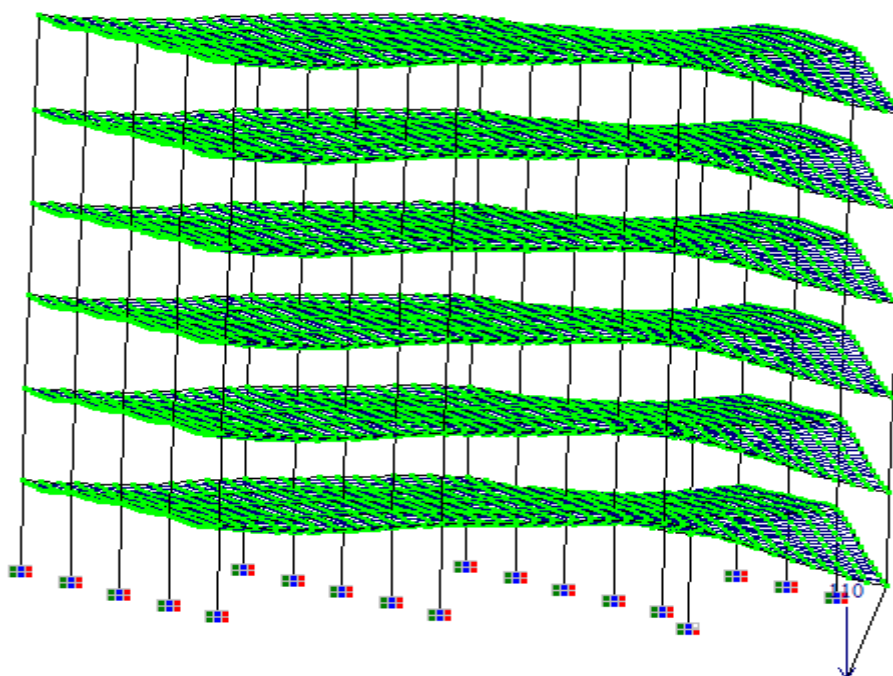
Schéma illustratif du comportement de la structure du bâtiment de 6 niveaux après le tassement du poteau d'angle
